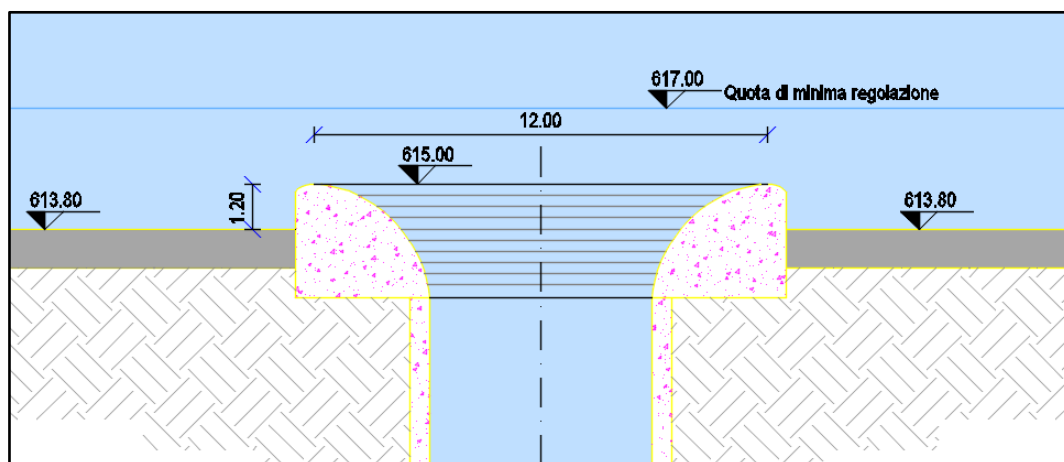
Vista Longitudinale dell'Opera di Presa e Restituzione di Monte
